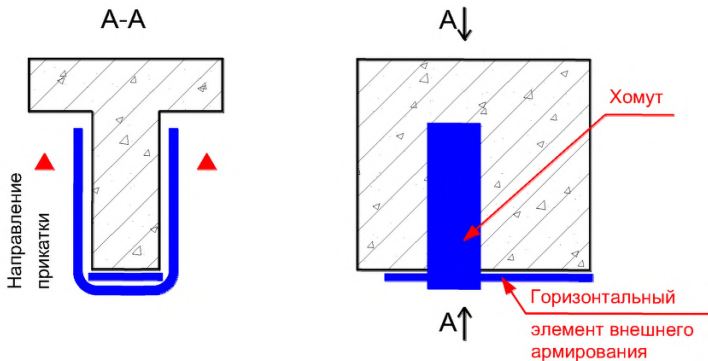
Схема установки вертикальных хомутов в балочных конструкциях
